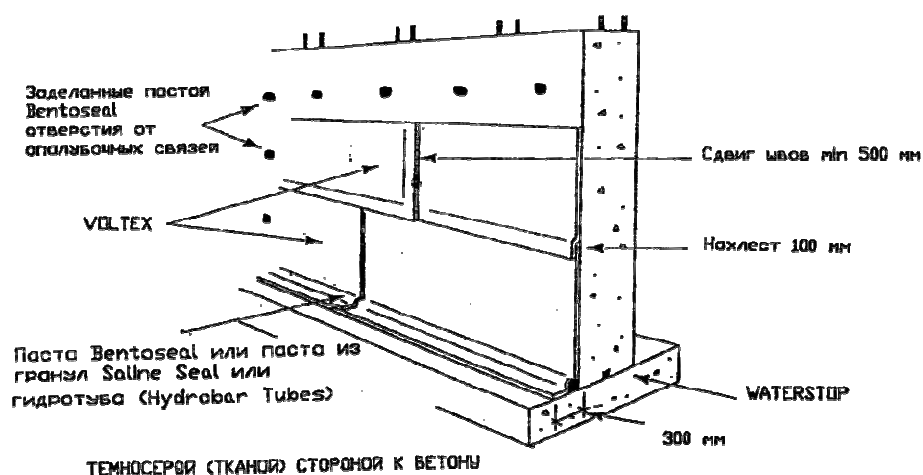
Укладка гидроизолирующих матов на вертикальную поверхность монолитного фундамента с креплением верха горизонтальной планкой и бентонитовой шпатлёвкой
